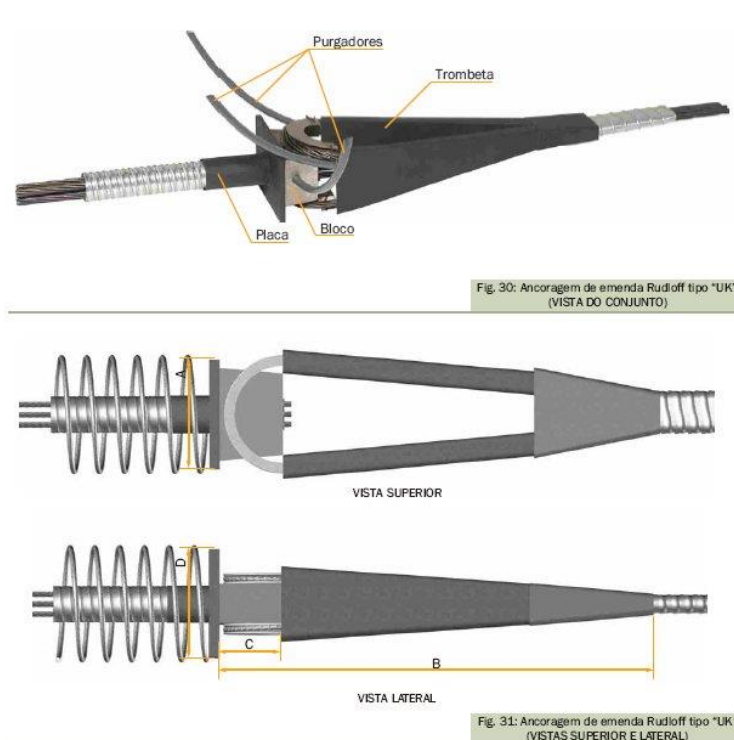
Dispositivo para emenda de armadura de protensão.
